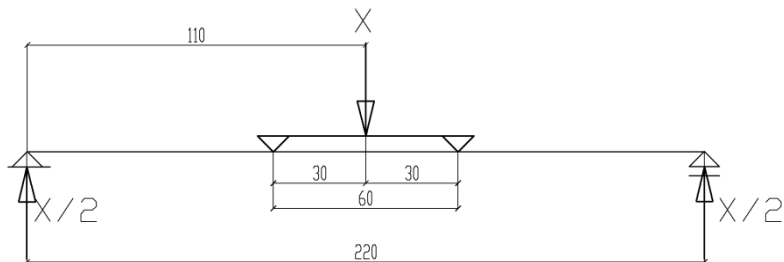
Схема на усиляване на стоманобетонните греди с текстилбетон [3]
